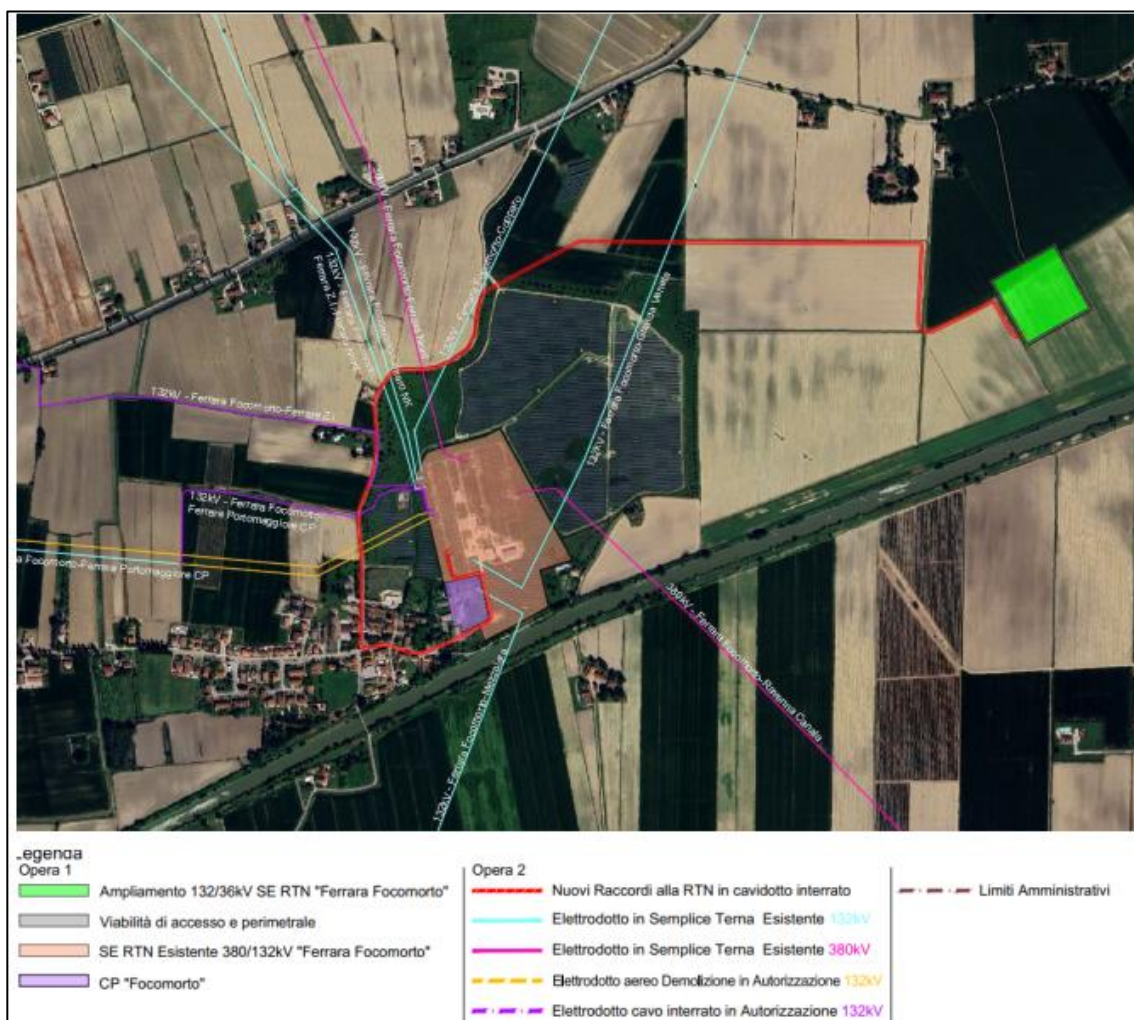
Sviluppo planimetrico territoriale delle opere in progetto
